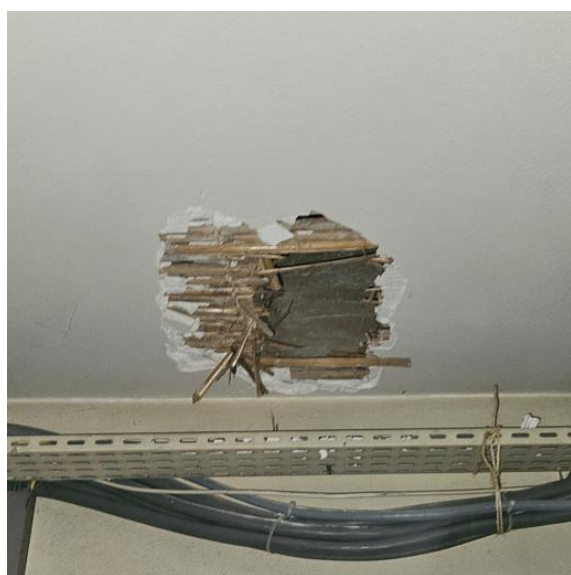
Sondage au droit de la cloison porteuse de l'escalier au R-1 (SS115)
